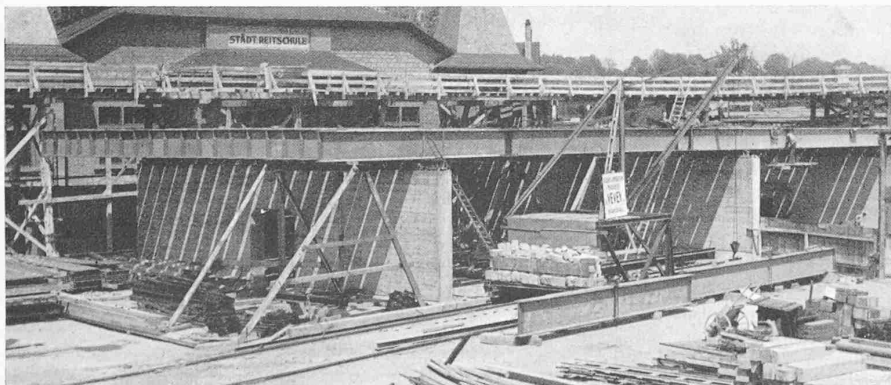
Trägerdecken des Loses 5 auf Eisenbeton-Pendelwänden. Durchgehende Träger Die 100, verstärkt durch aufgeschweisste Lamellen aus St 44
